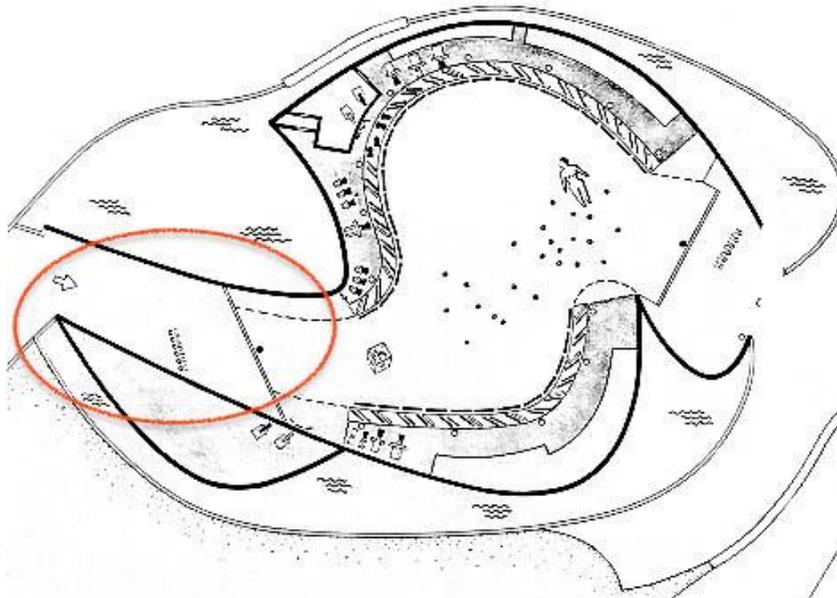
Planta baixa do *Pavilhão Philips* com destaque do hall de acesso.
